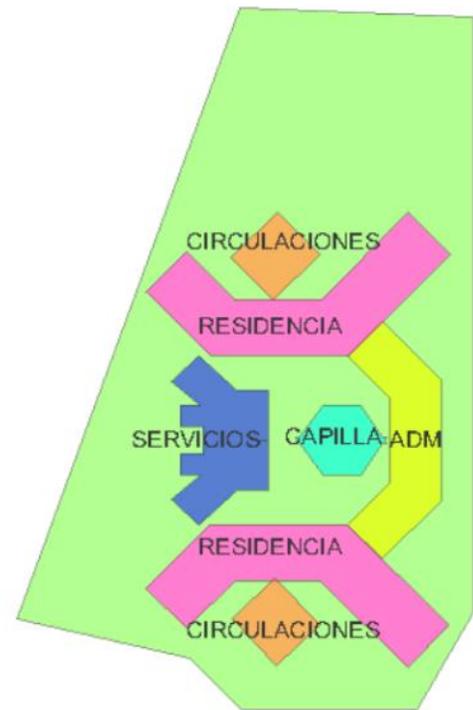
Planta Hogar de Ancianos Santa Teresa de Jornet
